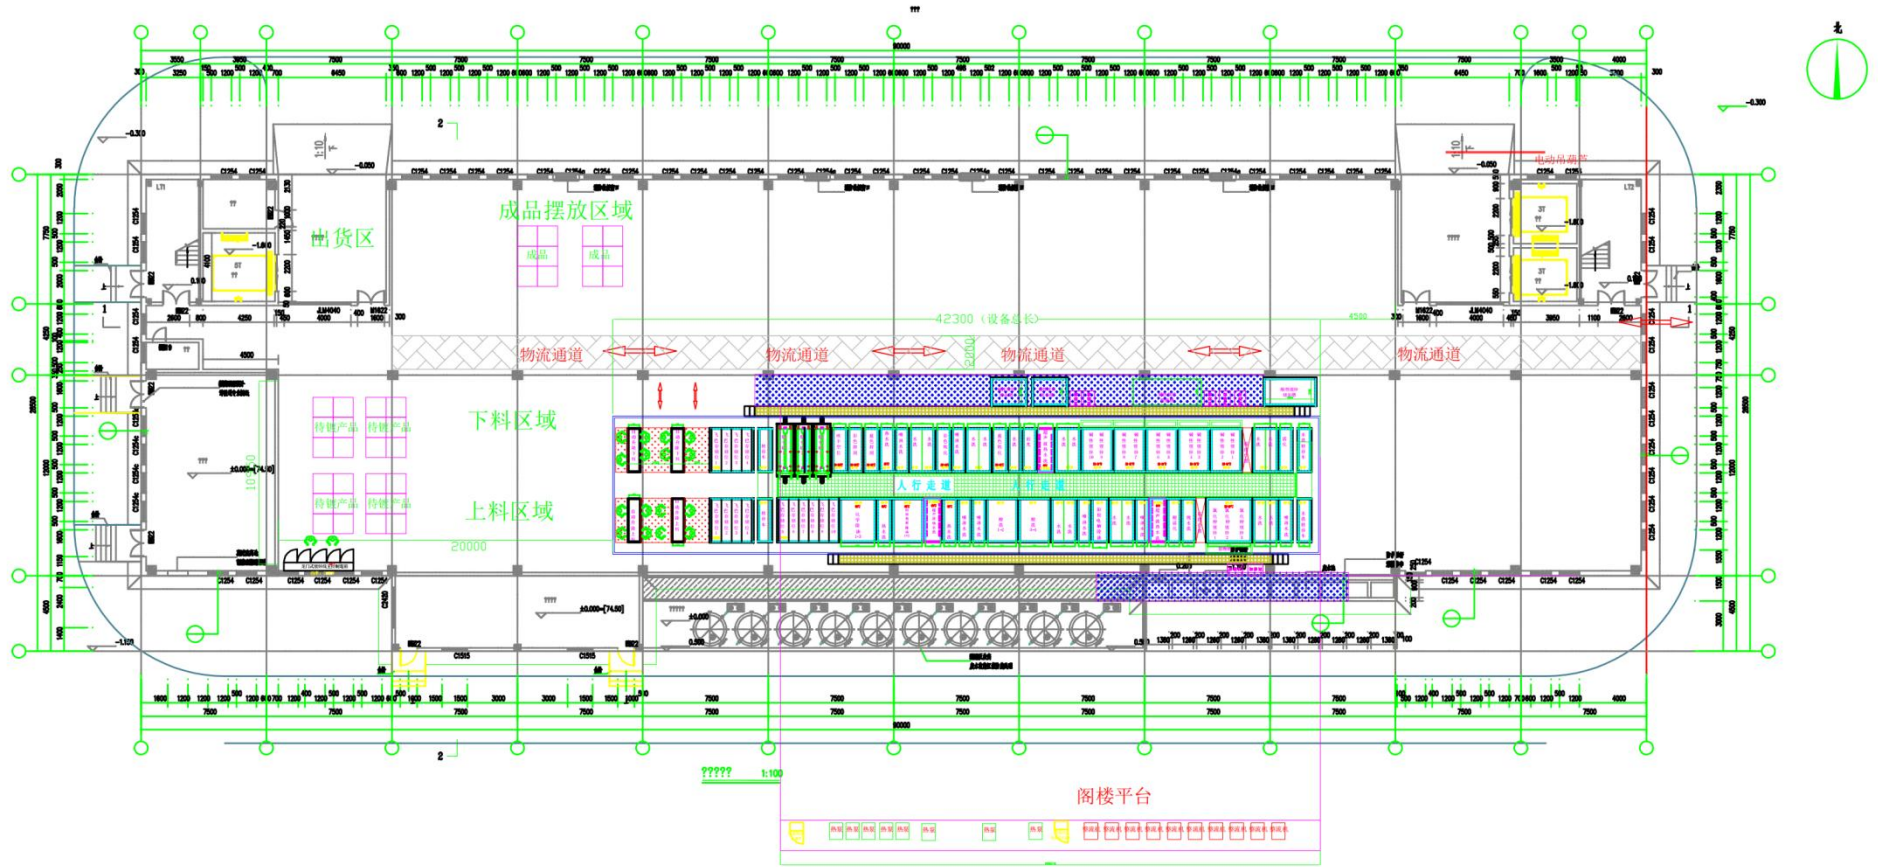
厂房 3 一楼挂镀锌线平面布置图
